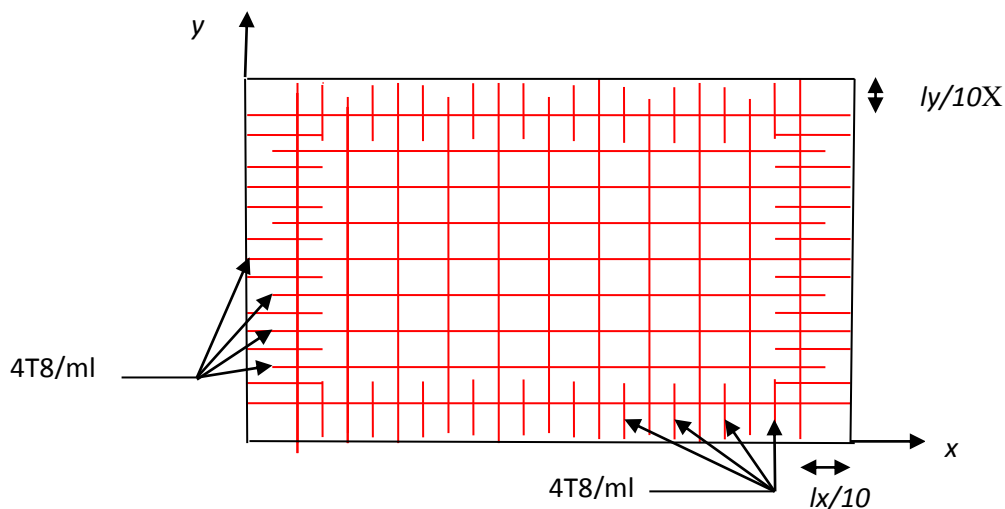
Schéma de ferrailage de la dalle de l'ascenseur.
